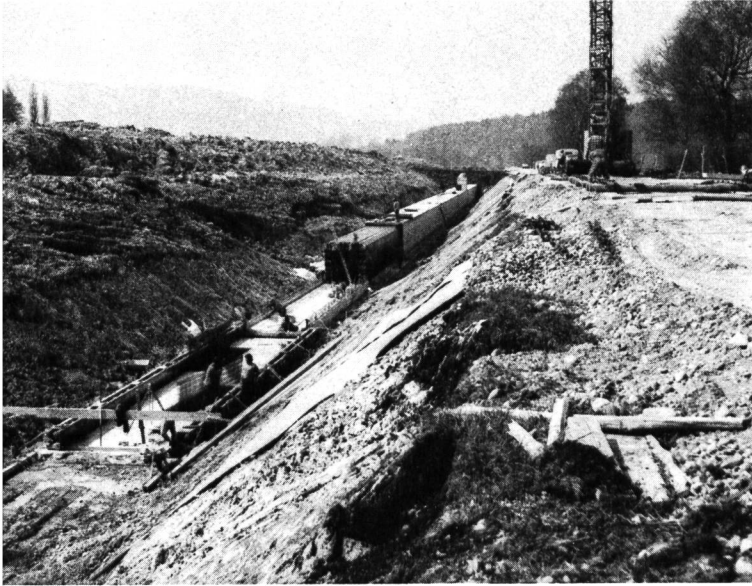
Verbandssammler Singen-Ramsen, Ausführung in Ortsbeton.
